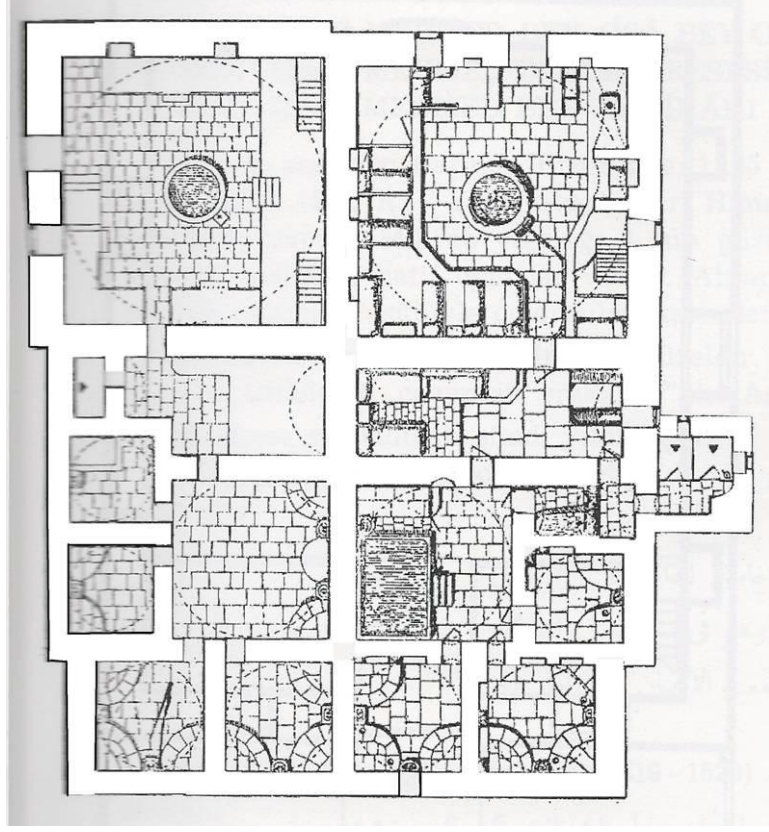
Fatih Sultan Mehmet Hamamı (Priştine) plan şeması
